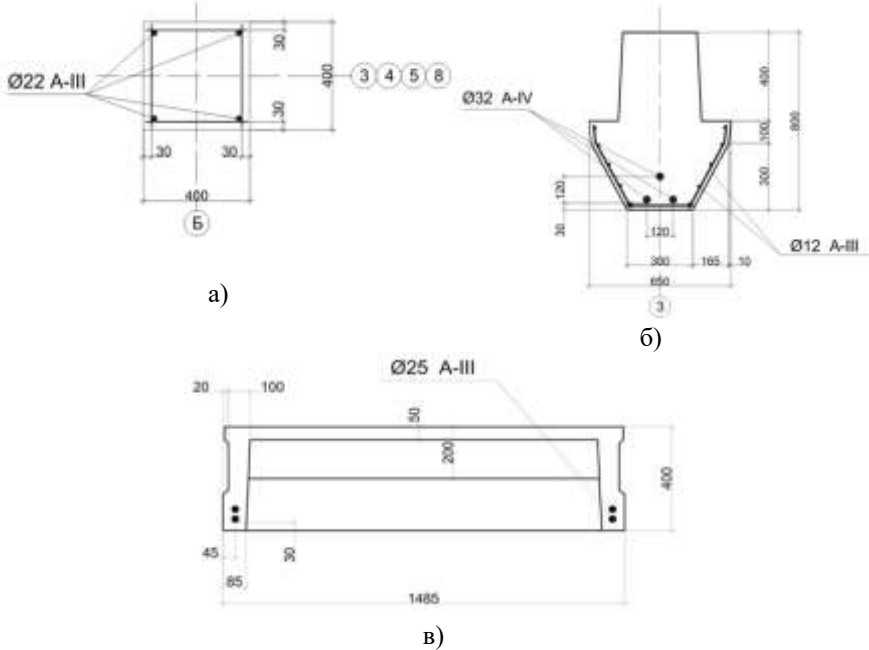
Поперечний переріз та його армування збірних залізобетонних несучих конструкцій каркасу надпідвального перекриття: а) збірна залізобетонна колона центрального ряду підвального поверху; б) збірний залізобетонний ригель; в) ребриста плита перекриття
